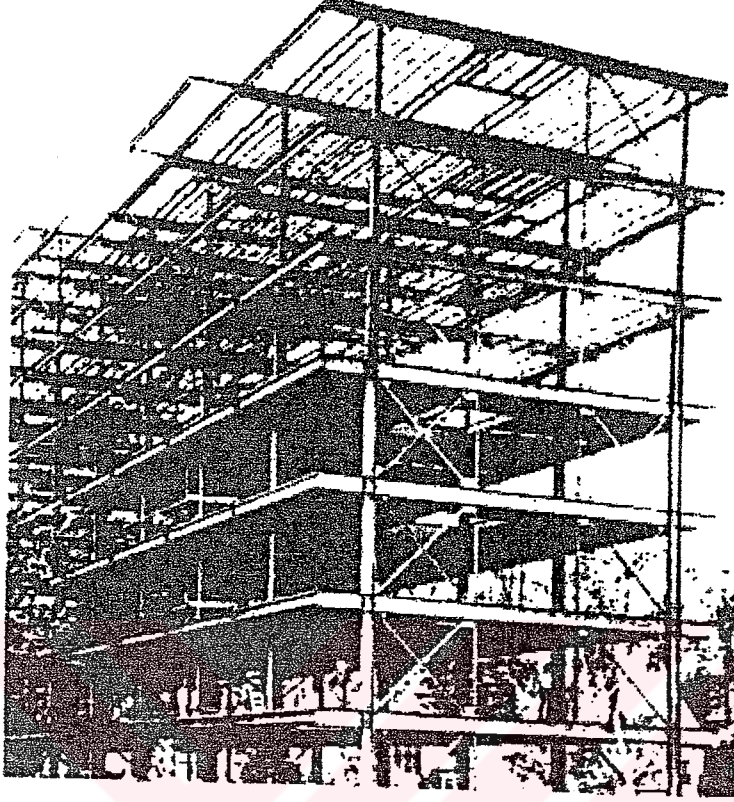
Woolworth Tower Binası New York 1913 (Tall, 1964)
